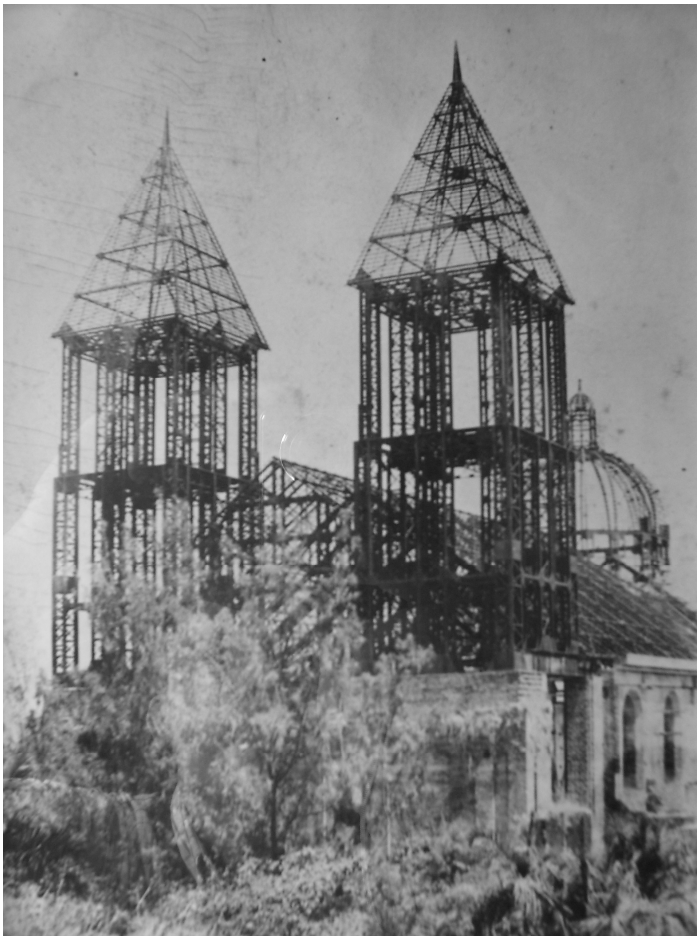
La fotografía muestra la catedral basílica, en pleno Proceso de Construcción, donde es fácil apreciar la estructura metálica utilizada en la construcción de las torres, cúpula y
